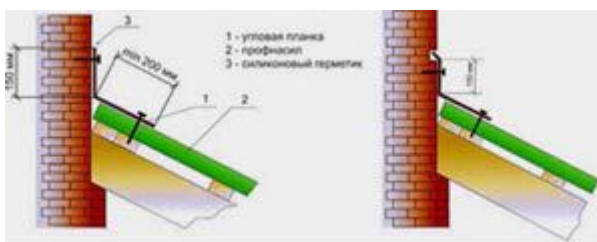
Продольное примыкание ската к стене. Угловая планка крепится с шагом 200 - 300 мм и с нахлестом между планками 100 - 150 м..
